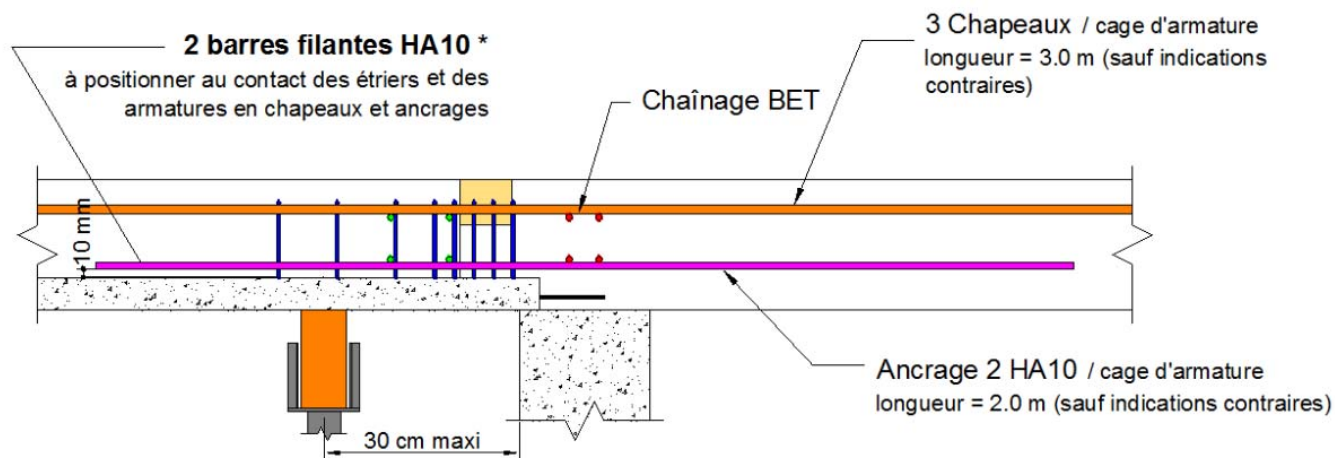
Exemple de disposition d'armatures complémentaires au droit des paniers – Coupe transversale (armatures de treillis soudé non représentées)
